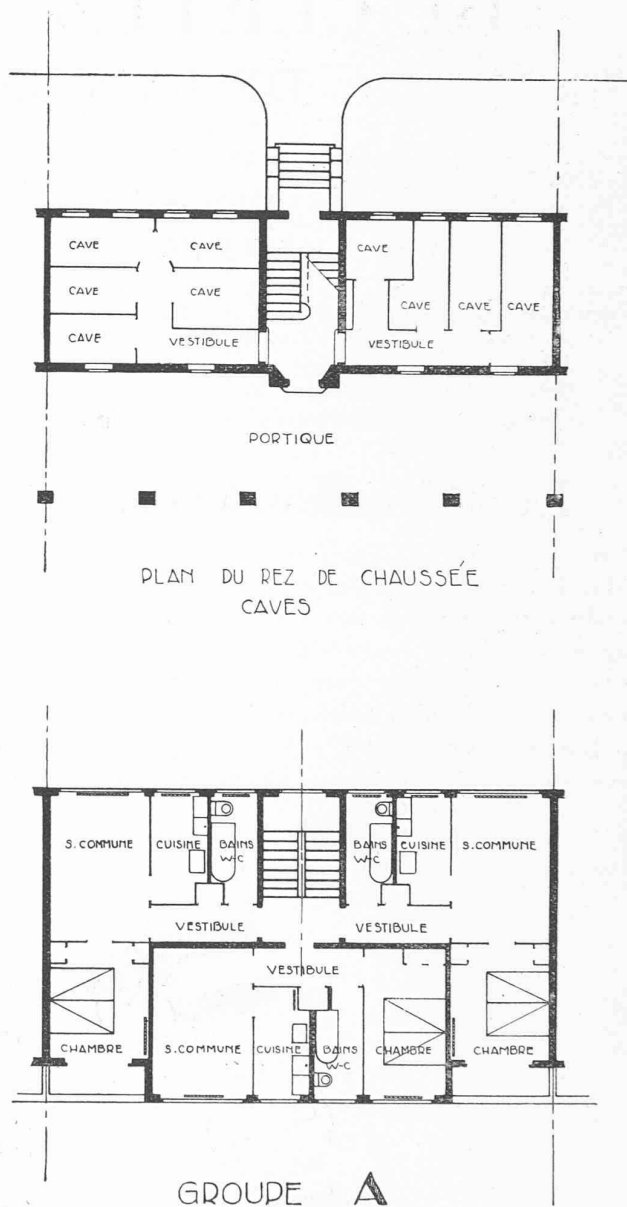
Plans du rez-de-chaussée et des étages.
